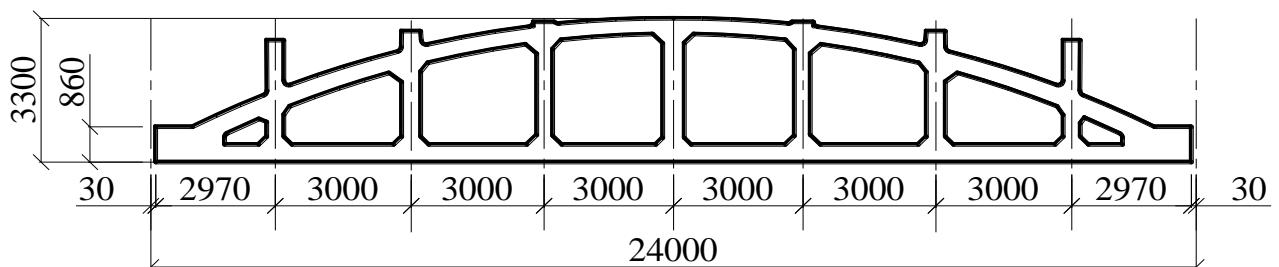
Безраскосная сегментная ферма для покрытий с малоуклонной кровлей
